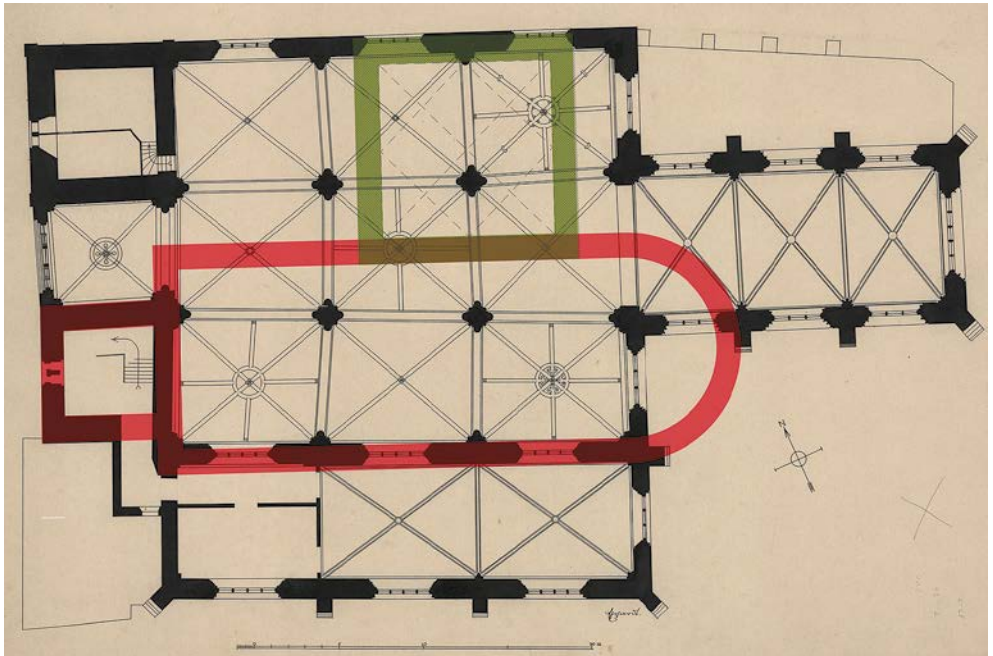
Unser Lieben Frauen, Grundriss Bau II mit Karner um 1100
